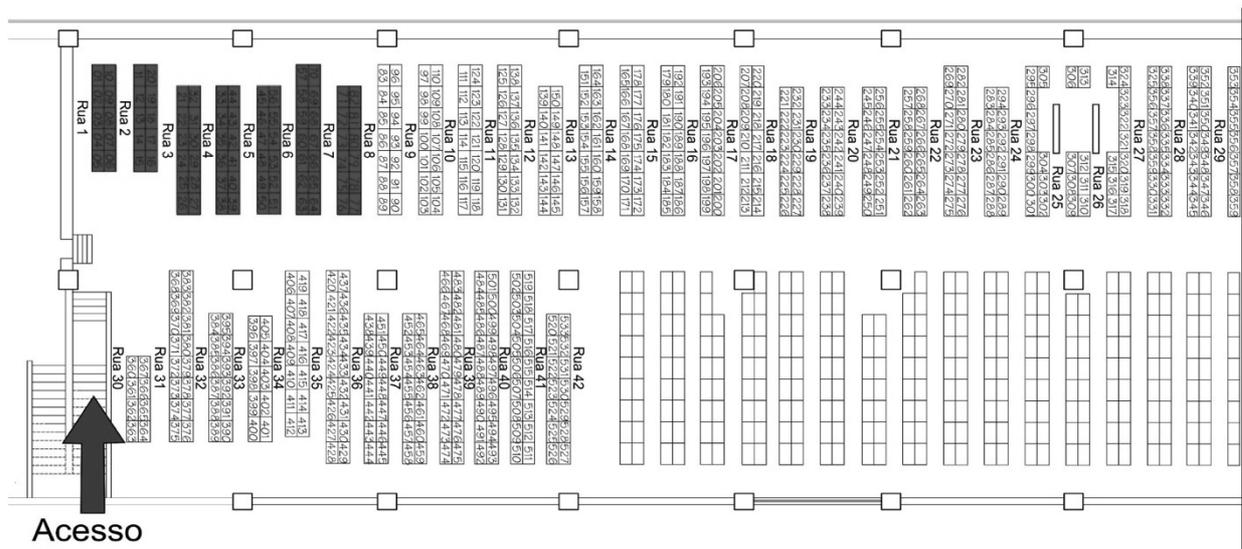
Planta baixa de localização do fundo DCDP no depósito Vermelho.
